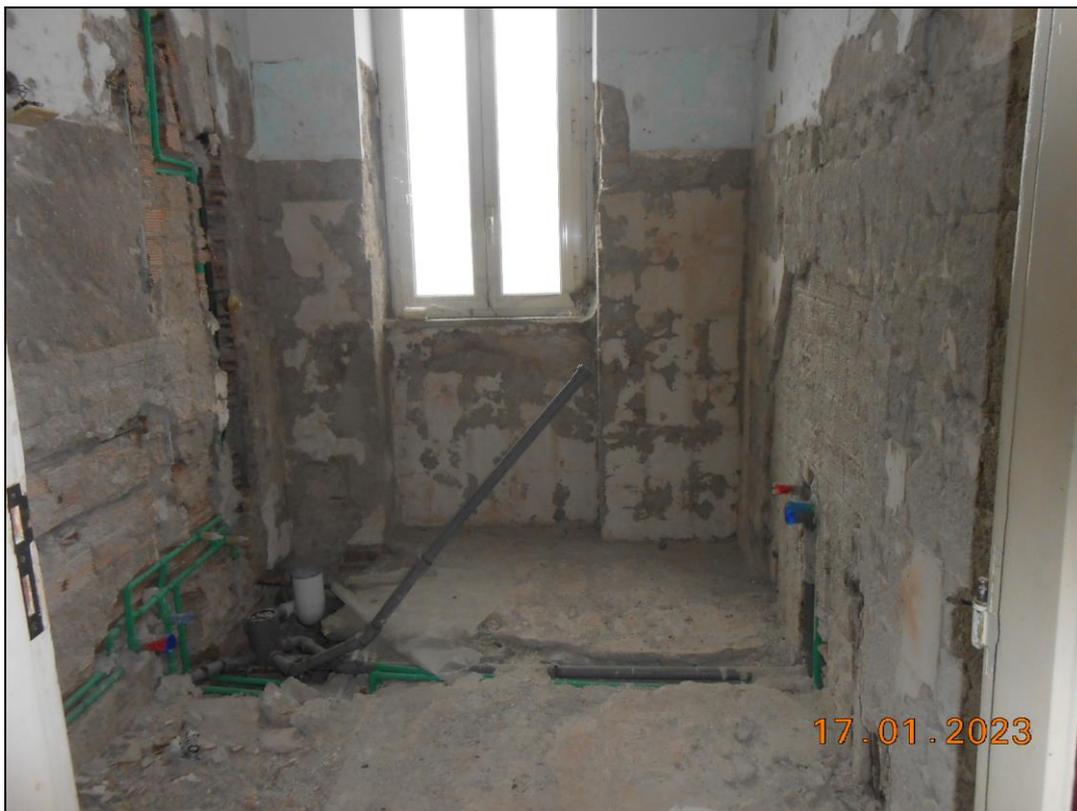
Vista interna del piano primo. Si notano i lavori di ristrutturazione, oramai fermi da molto tempo.
